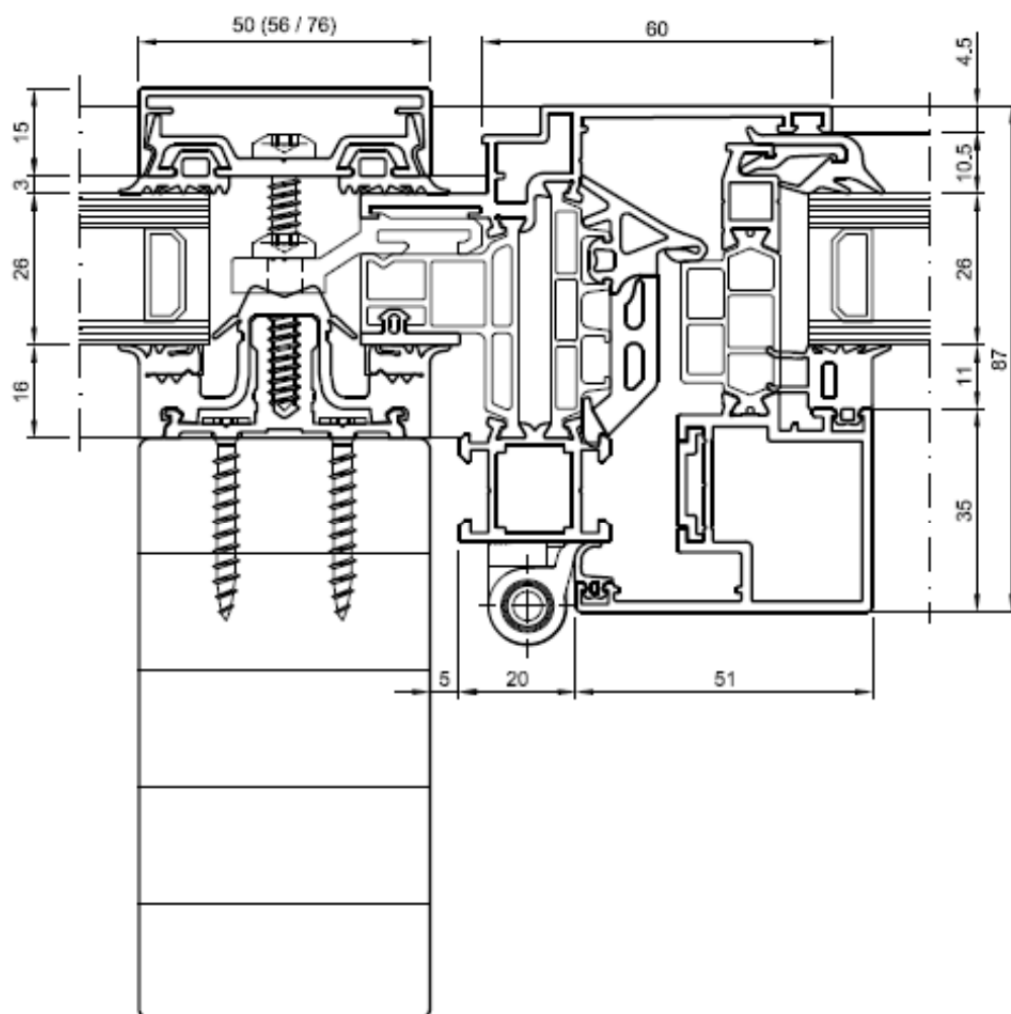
Exemple d'intégration d'un ouvrant en façade
